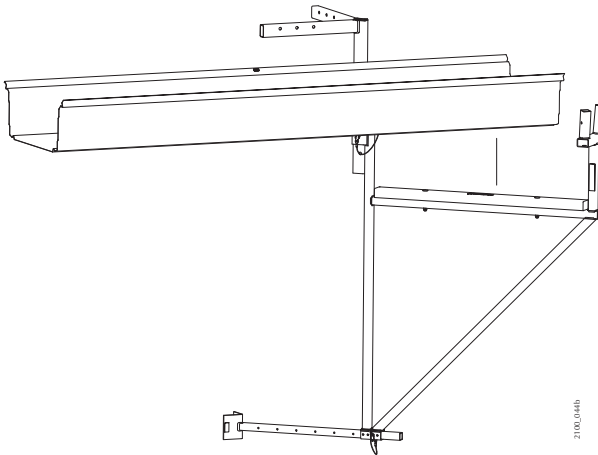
Montage des tôles de plancher sur la console de déport d'angle
